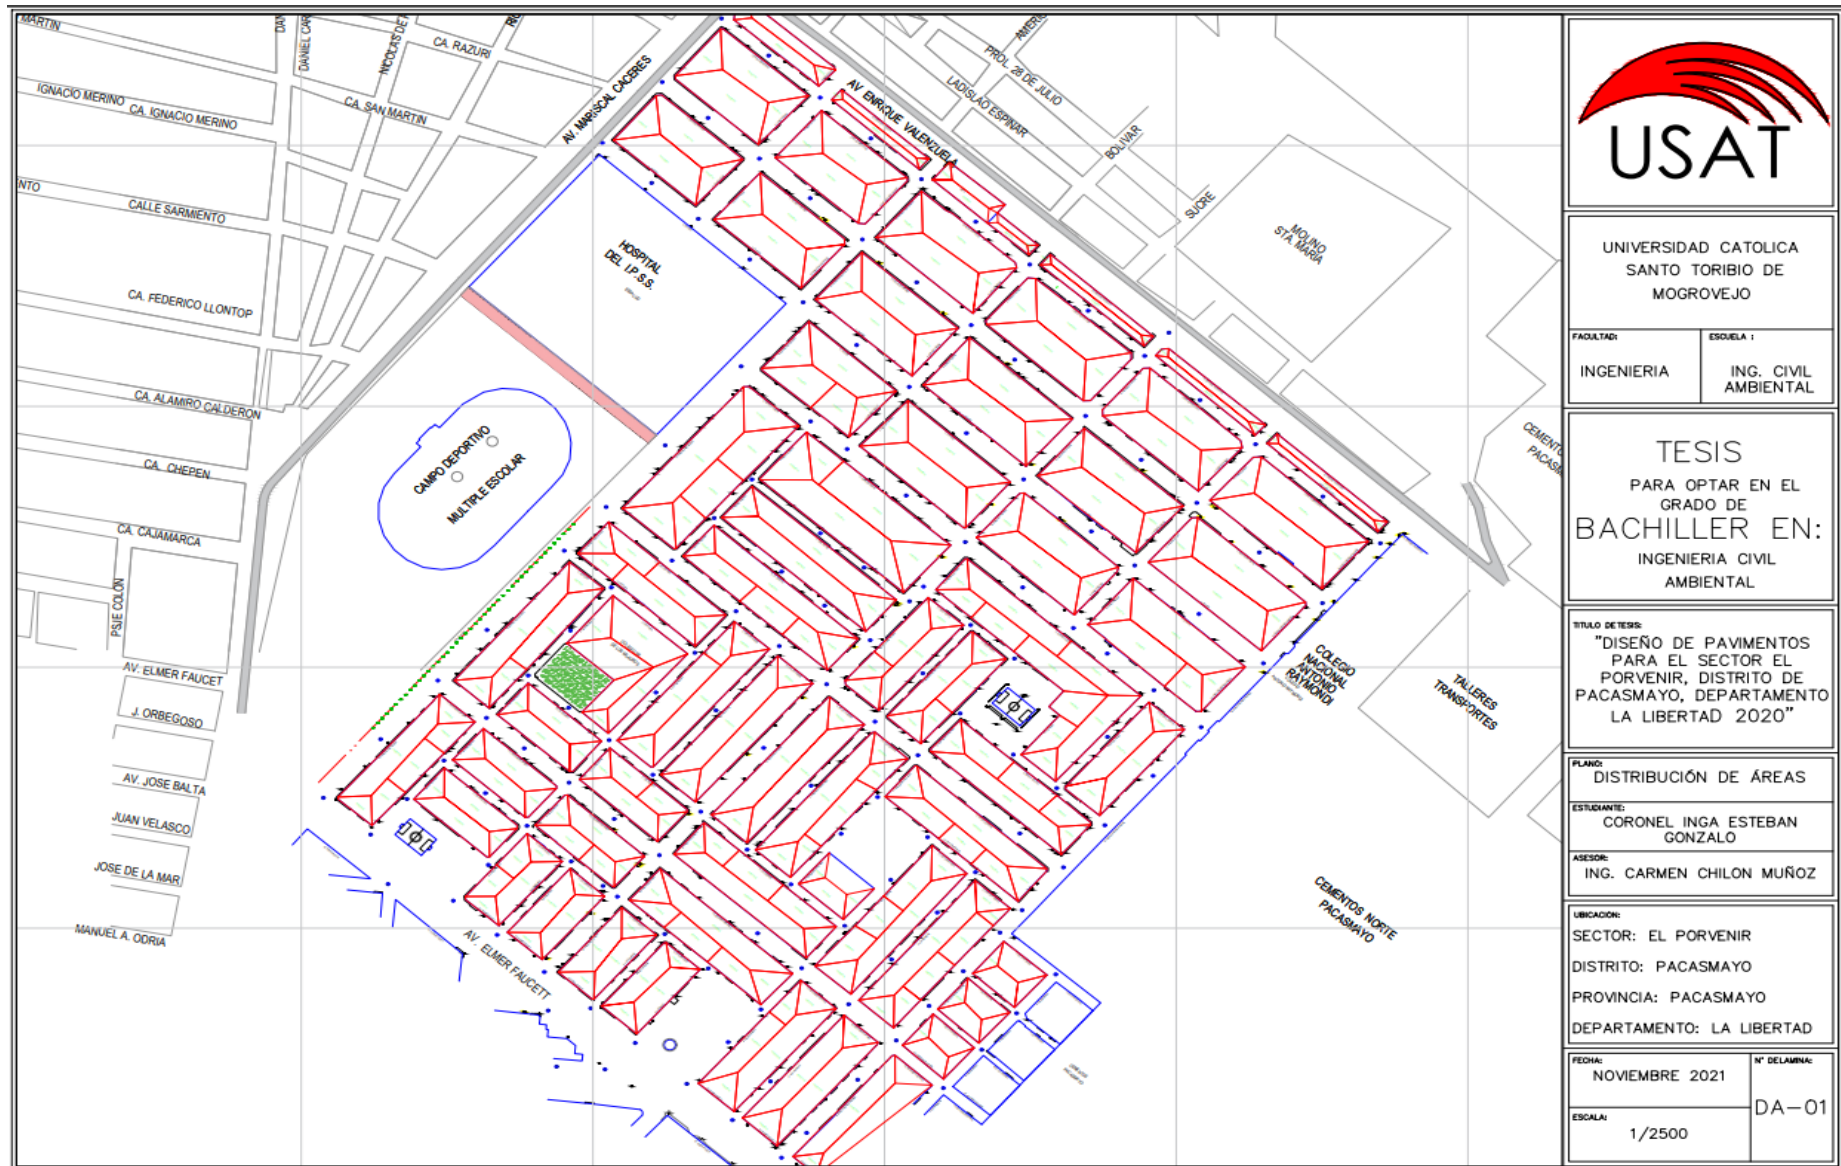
PLANO DE ÁREA TRIBUTARIAS DE APORTACIÓN DE VIVIENDAS- FUENTE: ELABORACIÓN PROPIA
